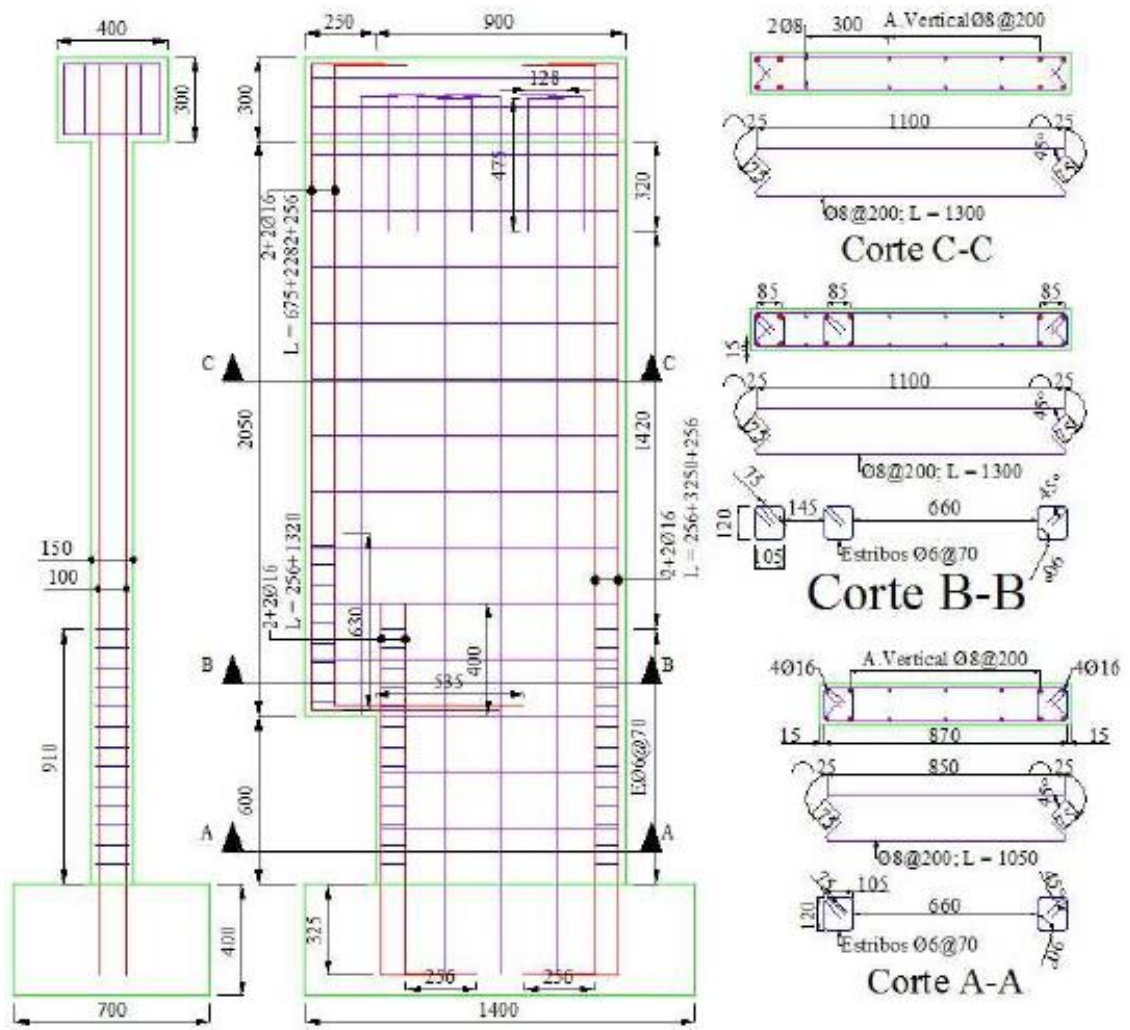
Detallamiento de la armadura de la probeta 3 de muros bandera.
